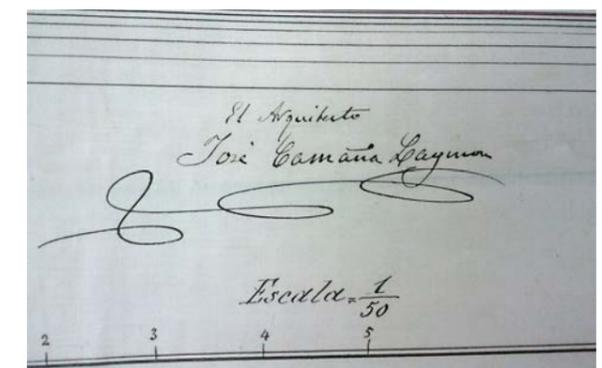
Firma del Arquitecto José Camaña Laymon.
